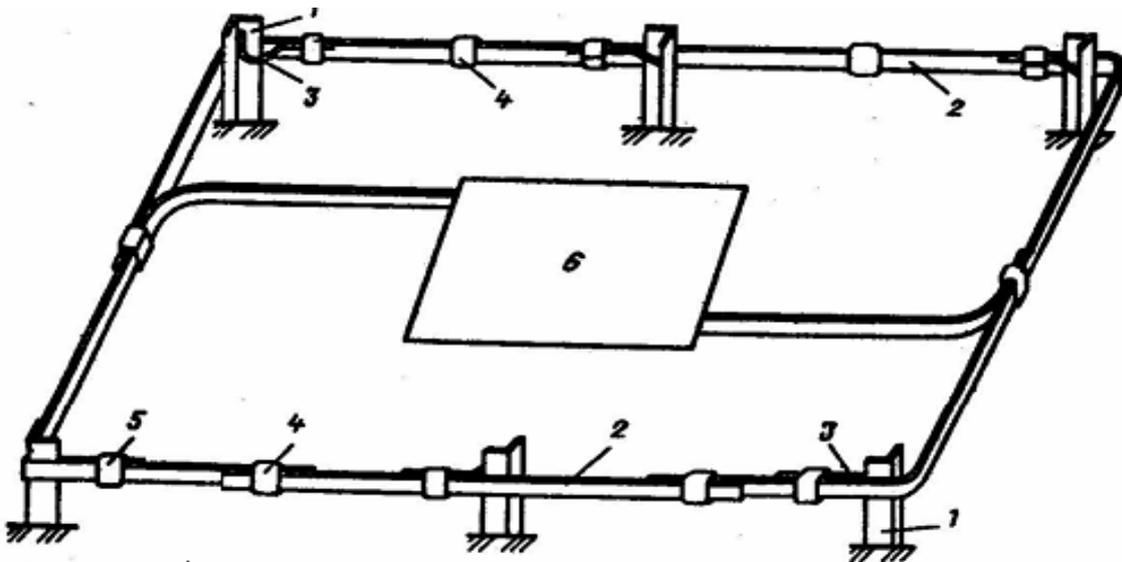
Общий вид заземляющего контура, выполненного методом термической сварки: 1 – вертикальный заземлитель, 2 – горизонтальный заземлитель, 3 – связь заземлителя с горизонтальным заземлителем, 4 и 5 – усиление в месте сварки, 6 – заземляемый объект.
